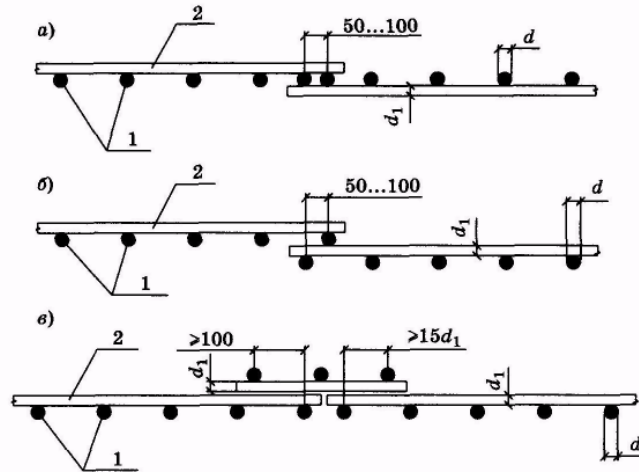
Стыки сварных сеток в направлении нерабочей (распределительной) арматуры: а — внахлестку с расположением рабочих стержней в одной плоскости; б — то же, с расположением рабочих стержней в разных плоскостях; в — стык впритык с наложением дополнительной стыковой сетки;  $d$ ,  $d_1$  — соответственно диаметры рабочей и распределительной арматуры; 1 — рабочая арматура, 2 — распределительная арматура
